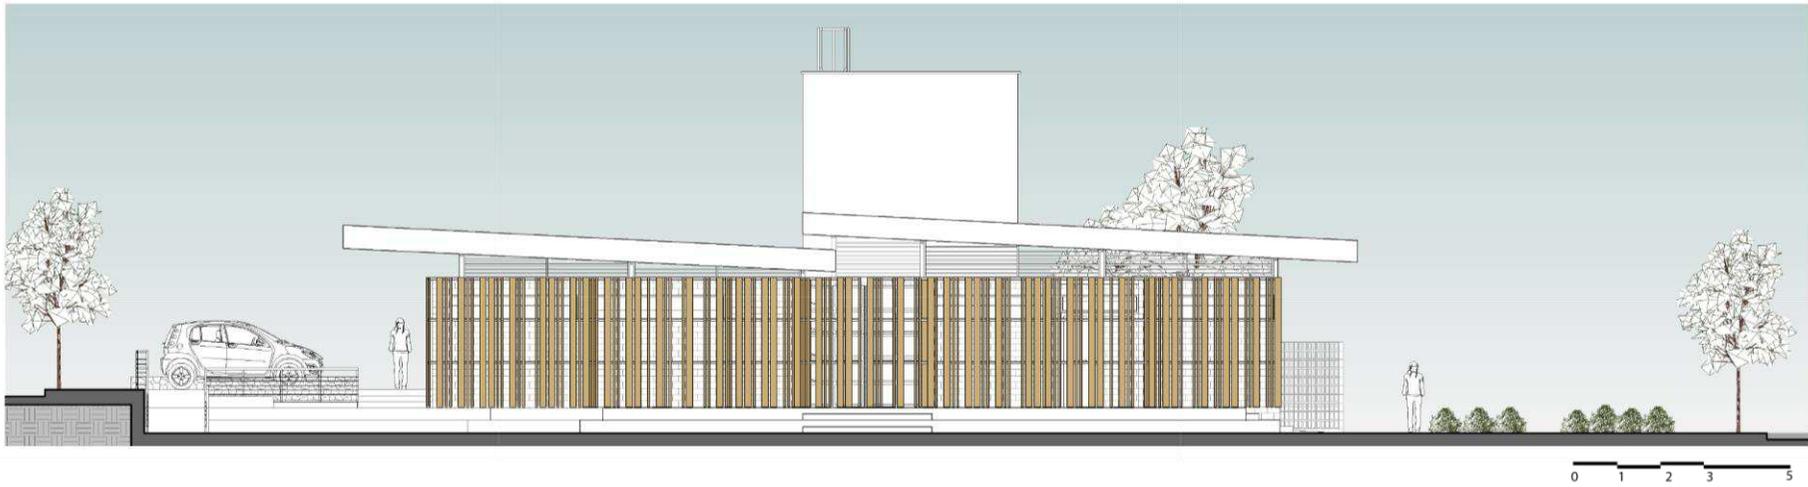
Fachada Oeste. Fonte: AUTOR, 2023
